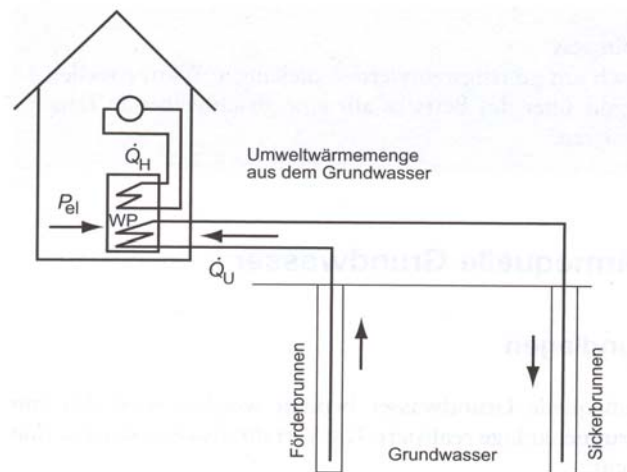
Grundaufbau einer Grundwassernutzung⁸
